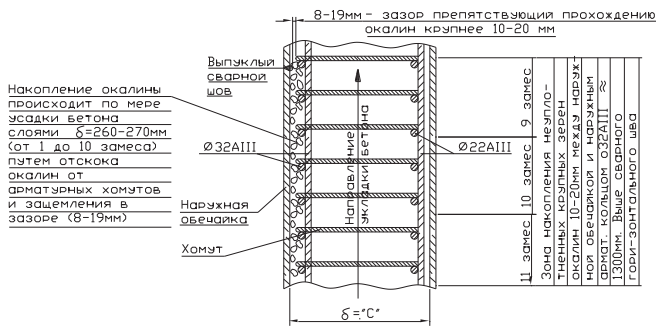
Узел накопления неуплотненных крупных зерен окалин 10 - 20мм между наружными арматурными кольцами и наружной обечайкой
